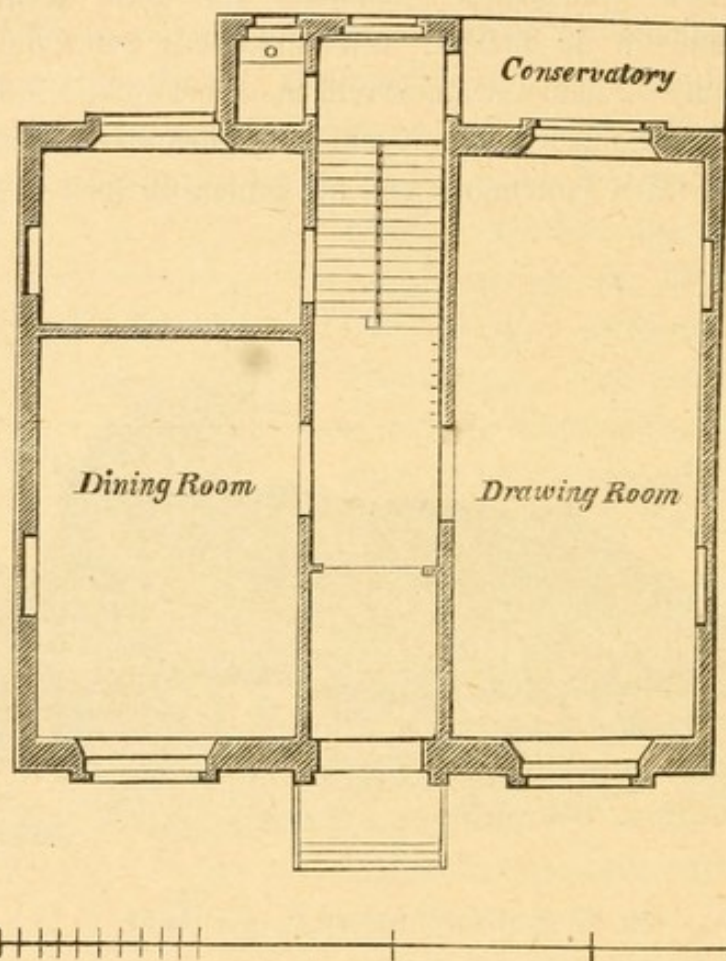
Grundriß eines englischen Wohnhauses: Erdgeschoß (Parterre).
